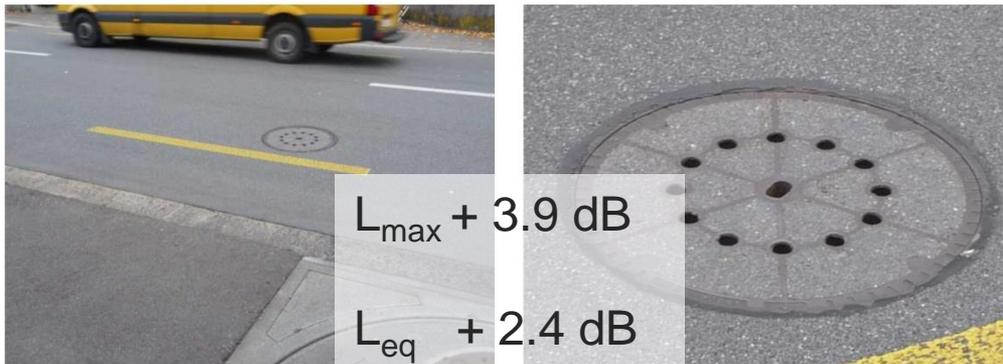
runder Schachtdeckel in Zofingen (Standarddeckel)
